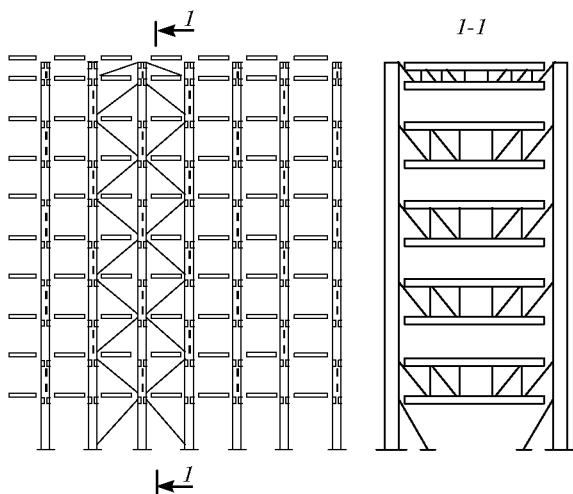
Связевый каркас с шахматным расположением поперечных вертикальных ферм
